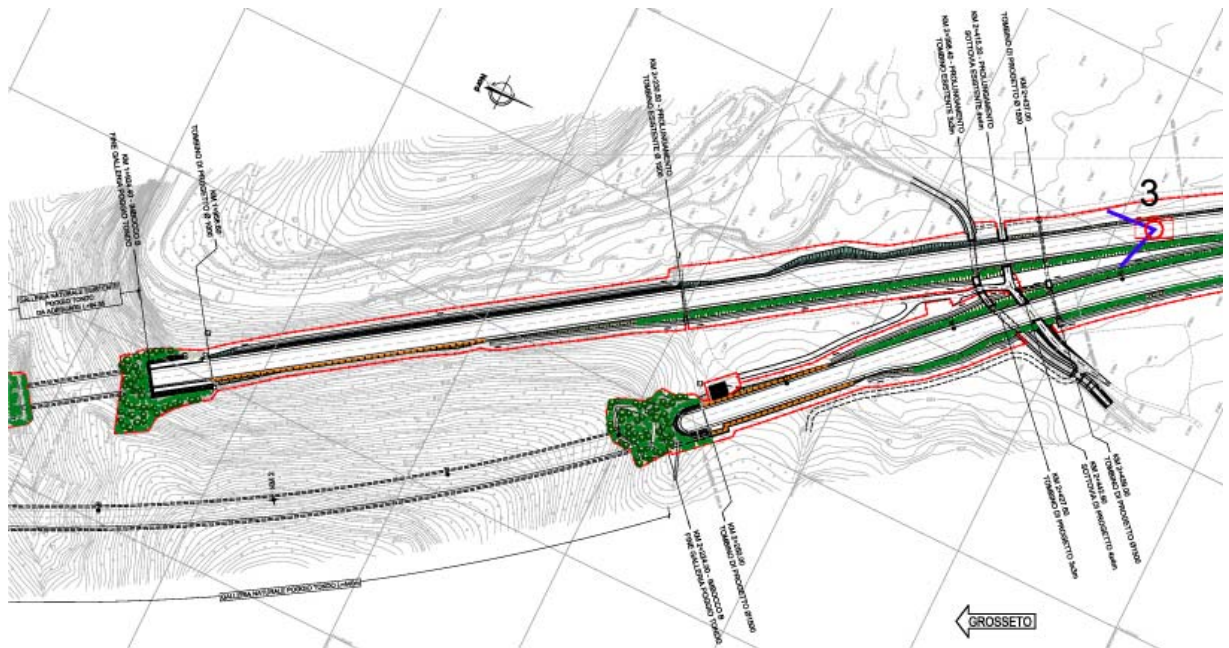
Vista 3 – Planimetria con mitigazioni e punto di vista fotografico
